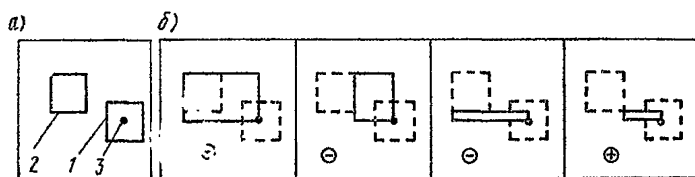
(2 прил. 3). Схема расположения «фиктивных фундаментав» для учета влияния на осадку по методу угловых точек
